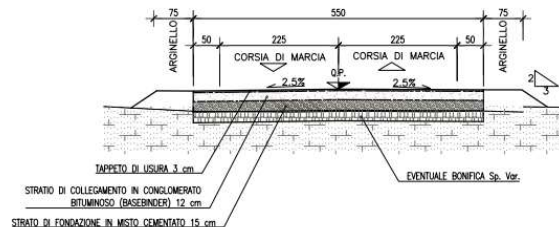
Sezione tipo complanare 5,5 m in rilevato
